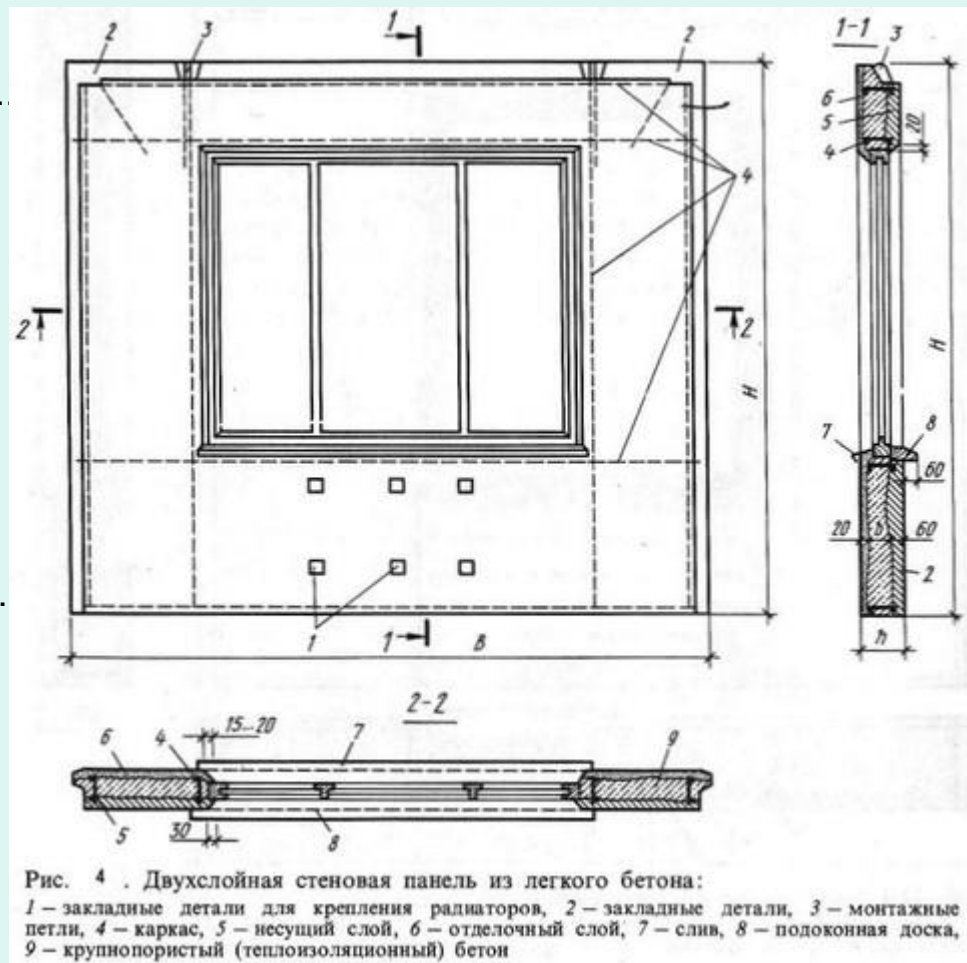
Двухслойная стеновая панель из легкого бетона:
